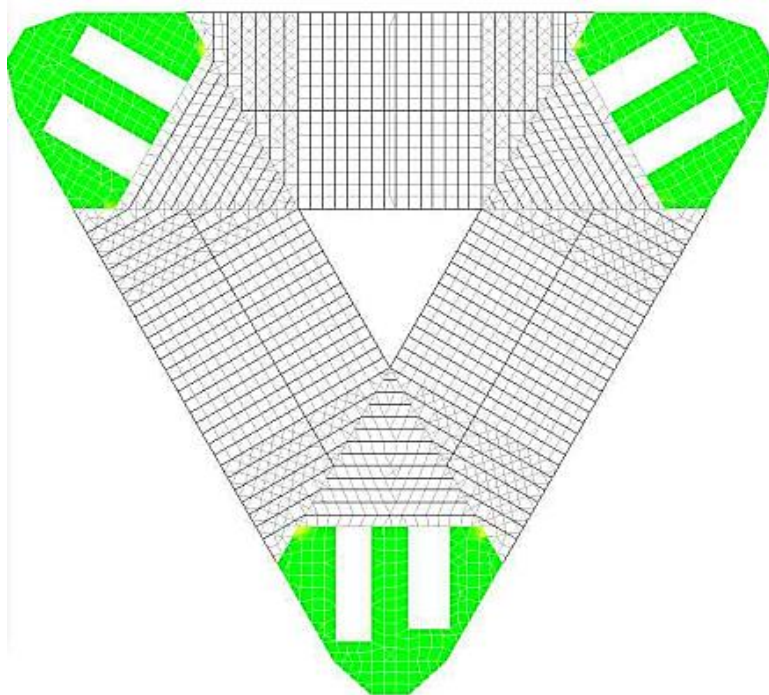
Діаметри верхньої арматури плит перекриття ядер жорсткості по осі Y, крок 200 мм
